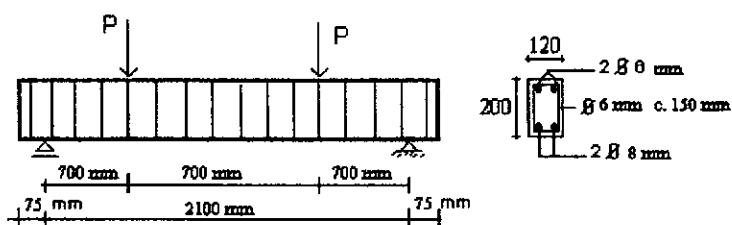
17 – Características das vigas ensaiadas por RIPPER et al.
